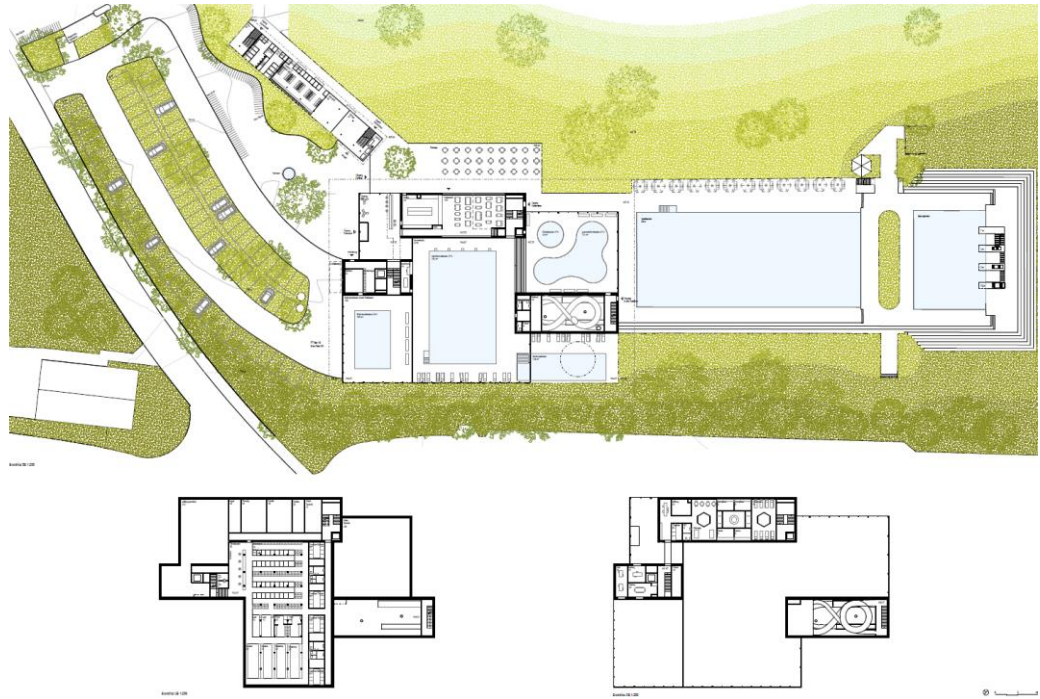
Grundrisse Erdgeschoss, Untergeschoss und Obergeschoss (ohne Masstab)
